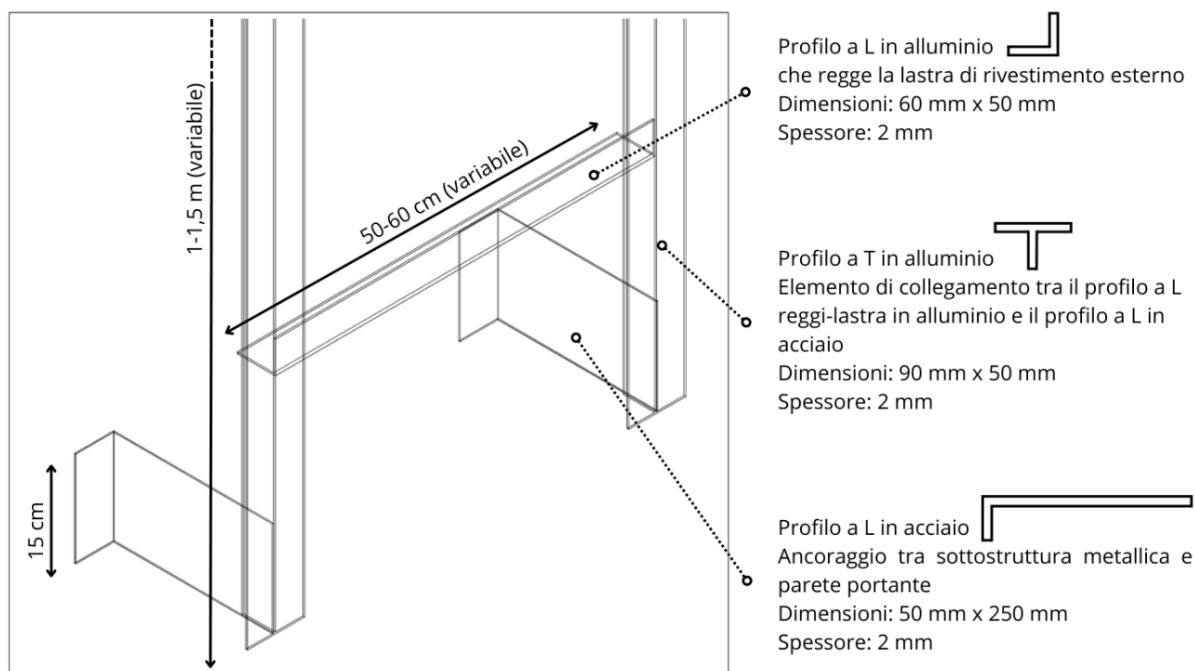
Layout della sottostruttura metallica della facciata ventilata
